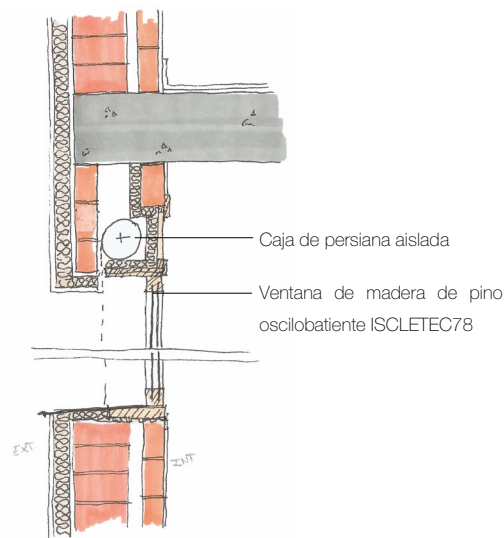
Detalle carpinterías de madera y caja de persiana aislada con el sistema SATE implementado en los muros de fachada (autoría propia).
